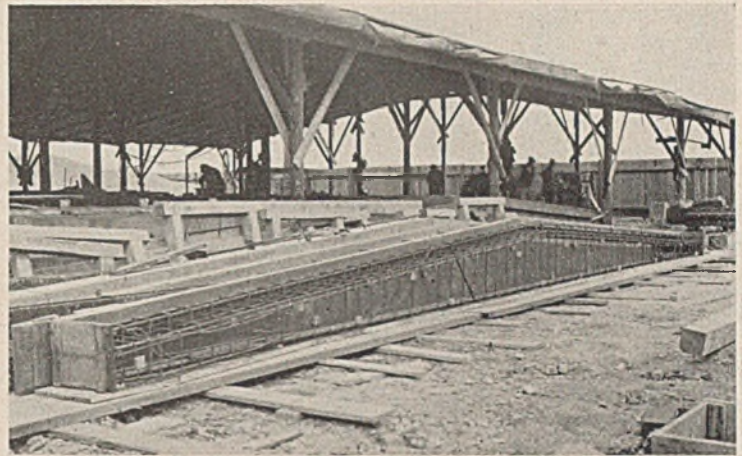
Bewehrung eines 10 m langen Dachträgers. Im Hintergrund eine mit Planen überdachte Werkstatthalle.
